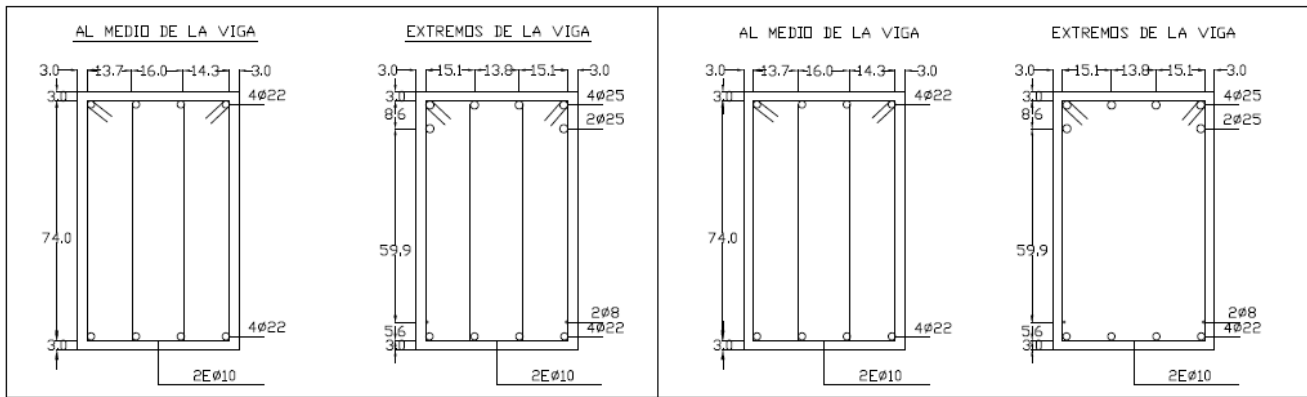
Sección transversal de las vigas del piso 3 del caso de estudio 2
